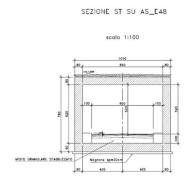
Viabilità AS\_E48 sezione tipo in sottovia.
